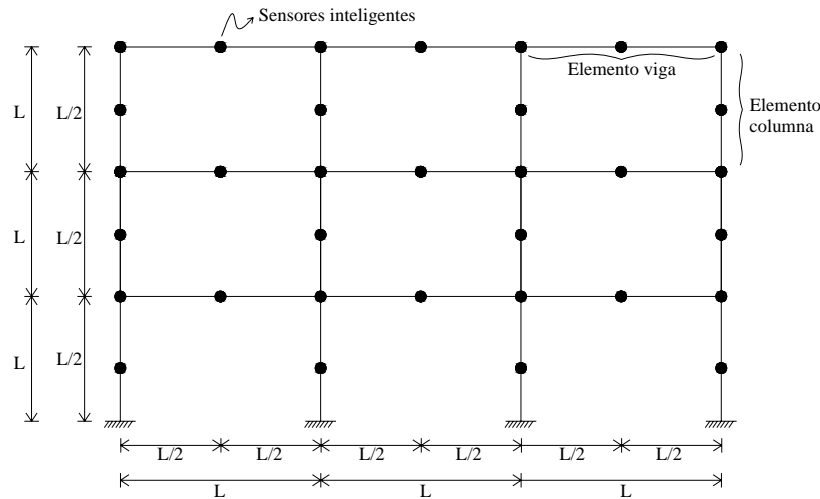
2. Colocación de los sensores, intersecciones viga-columna y en la parte central de cada elemento.
